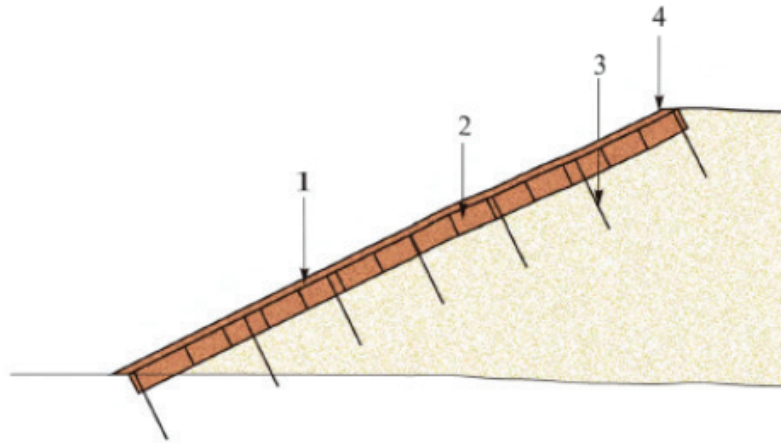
Конструкция укрепления откоса неподогреваемой насыпи высотой до 3 м объемной георешеткой
